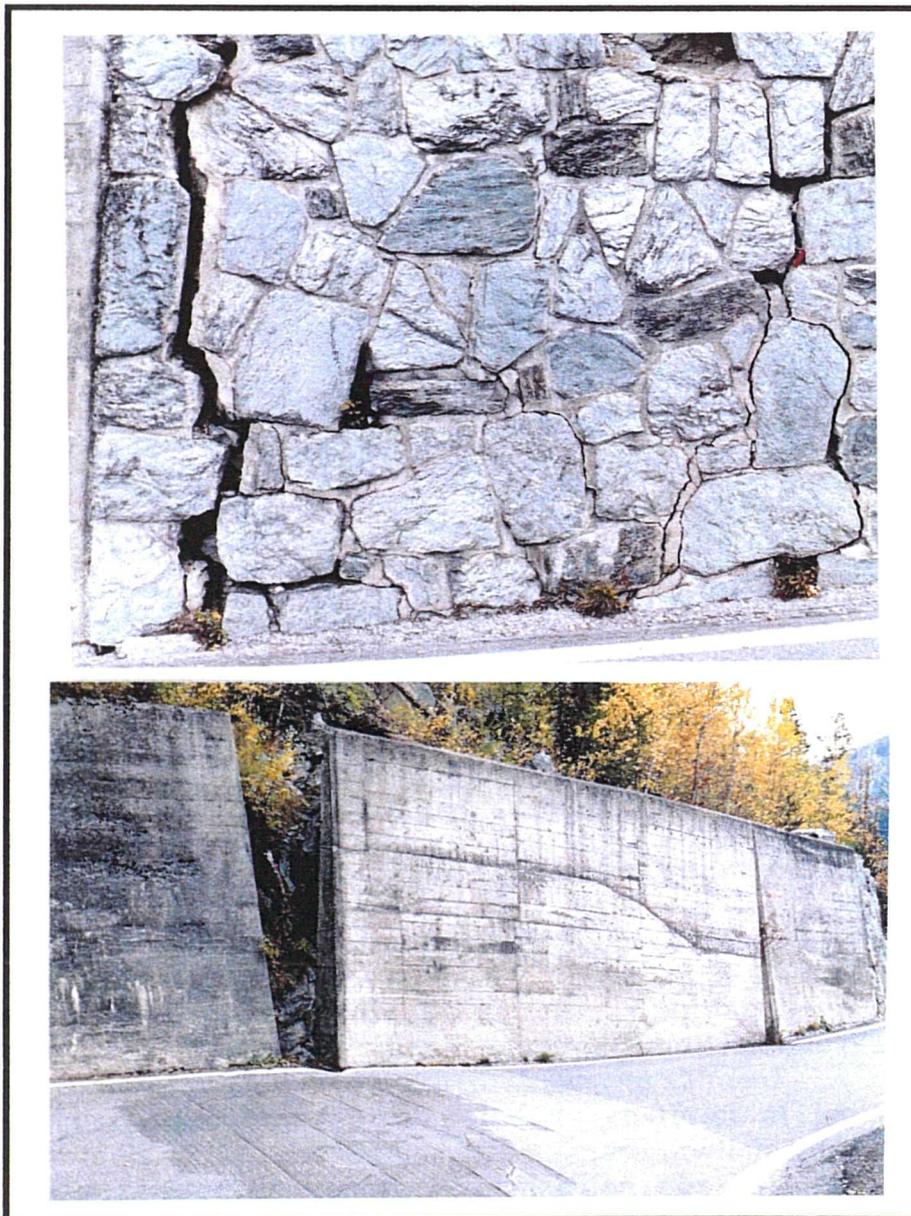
Sur la route cantonale, basculement et fissuration des ouvrages de protection liés au glissement.
